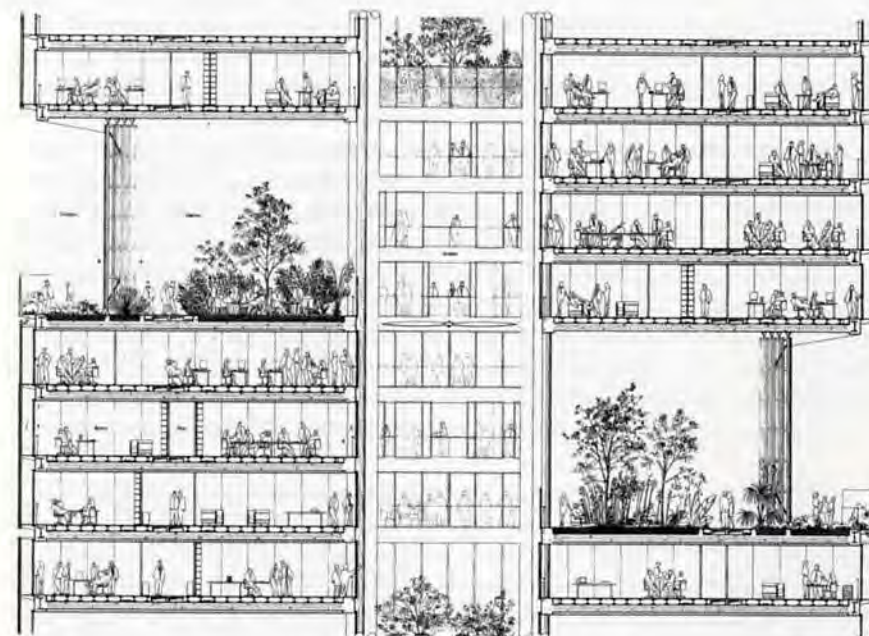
Norman Foster: detalle de sección con jardines, torre sede del Commerzbank, Frankfurt am Main, 1991 (en revista A.V., n°38, p.90)
